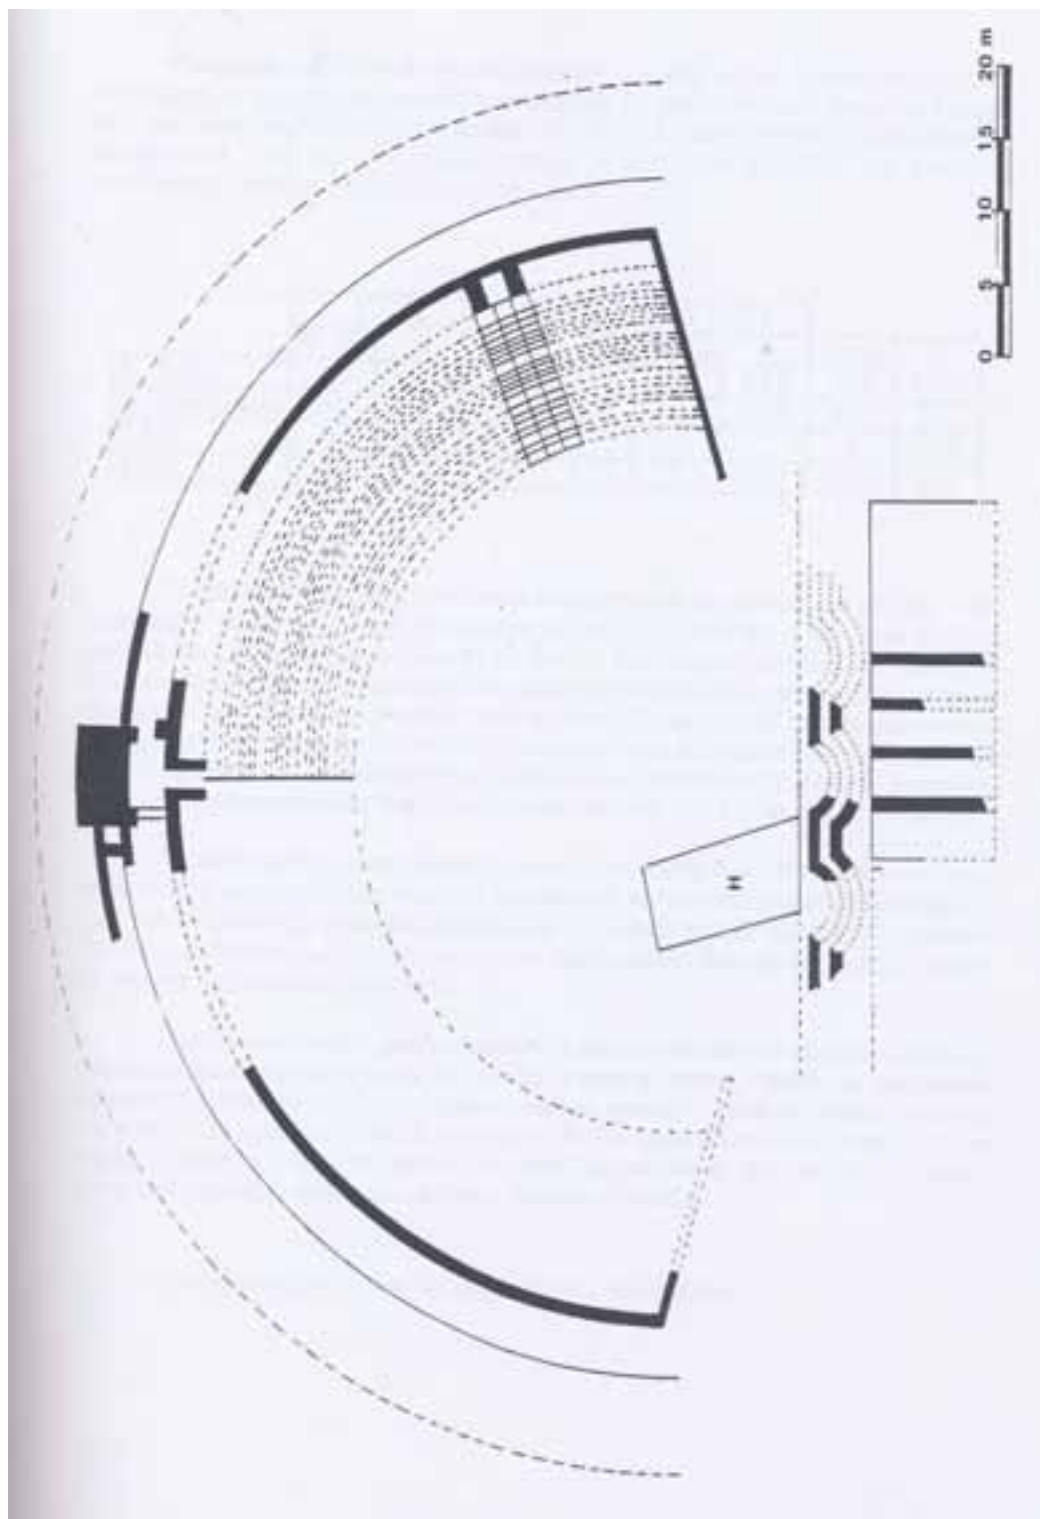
Reconstrucción de la planta del Teatro (Según M. Martín-Bueno y J. Núñez)
